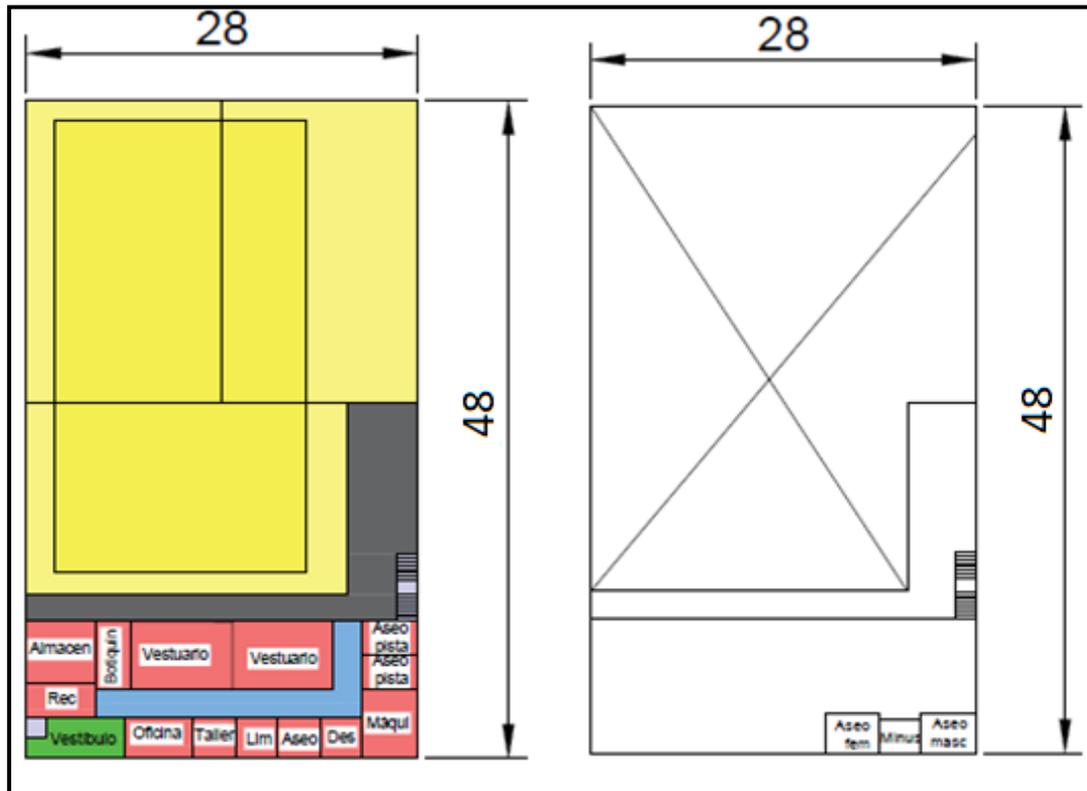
Distribución de los espacios de la alternativa 1. Planta baja (izquierda) y Planta 1 (derecha). (Fuente: Elaboración propia).
